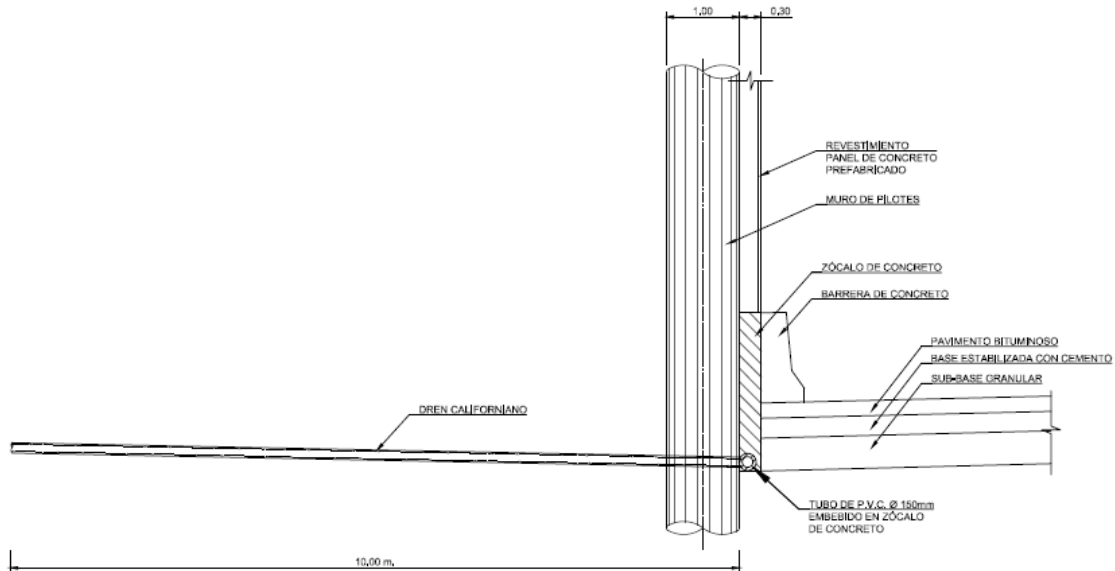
Detalle del drenaje en el muro de pilotes de los bastiones
